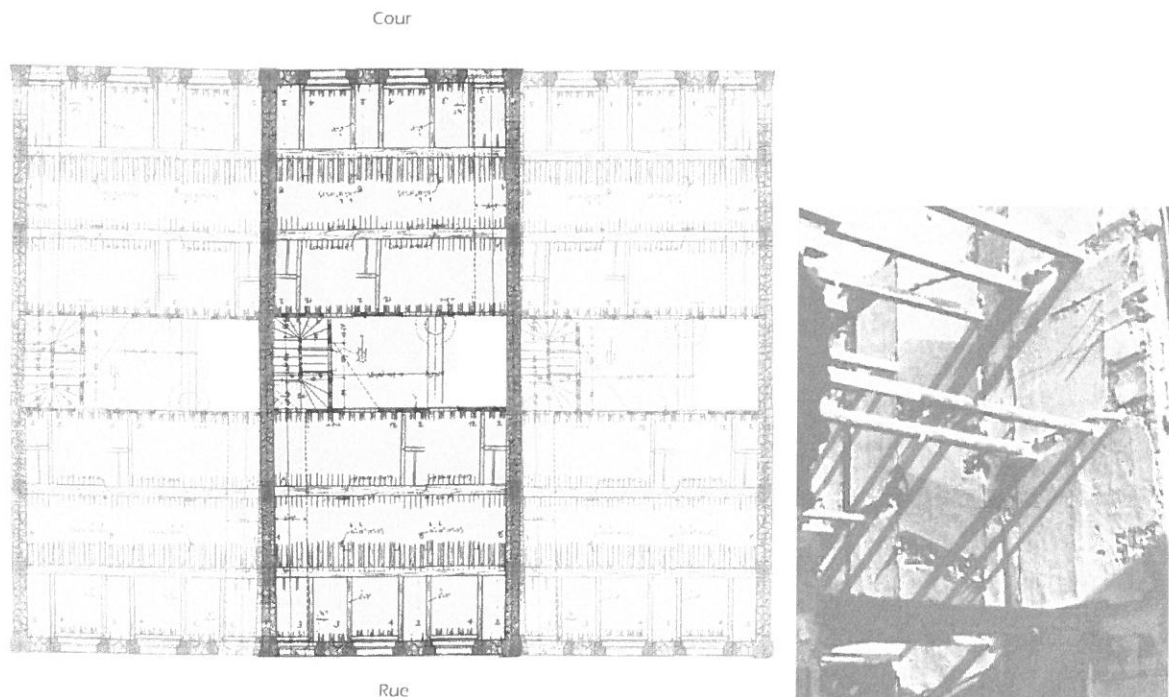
Plan de trois immeubles d'habitation type Trois Fenêtre Marseillais. Les murs de refend porteurs sont les murs les plus longs et perpendiculaires aux façades. A droite, une photographie d'un Trois Fenêtre Marseillais où il ne reste plus que les poutres de plancher et les murs de refend.
